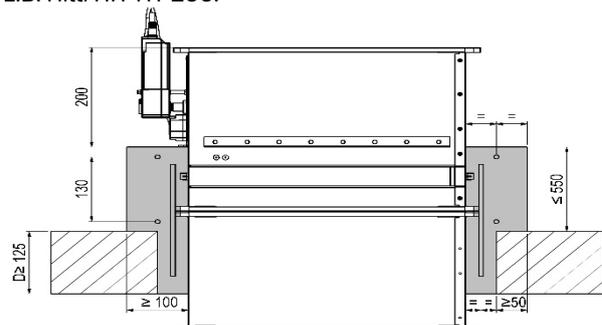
Einbau in massive Decken mit Betonsockel, Schnitt
